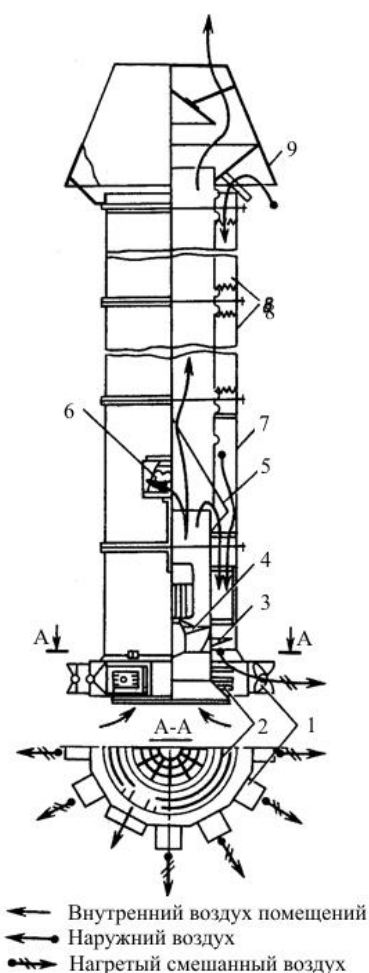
Приточно-вытяжная установка типа ПВУ:
